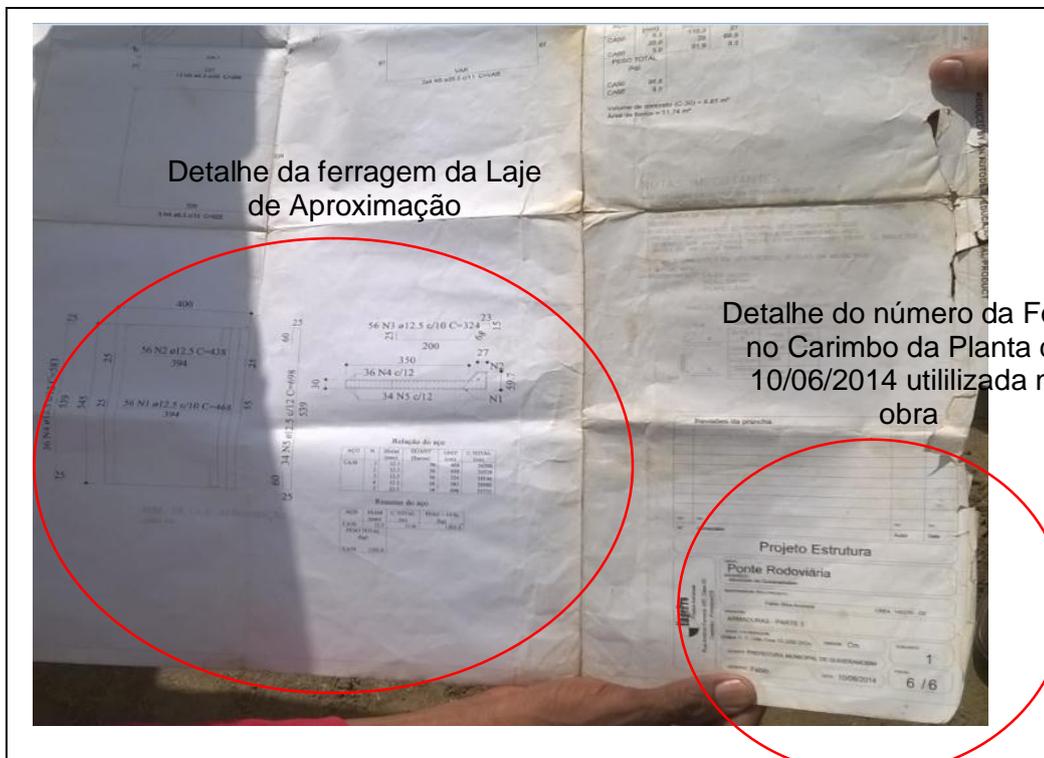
É Projeto de Estruturas Existente na Obra Armaduras Parte 3 (Folha 6/6)
